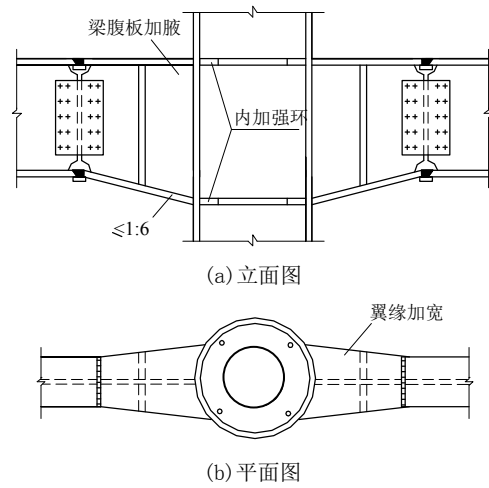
翼缘加宽、腹板加腋的悬臂钢梁与
